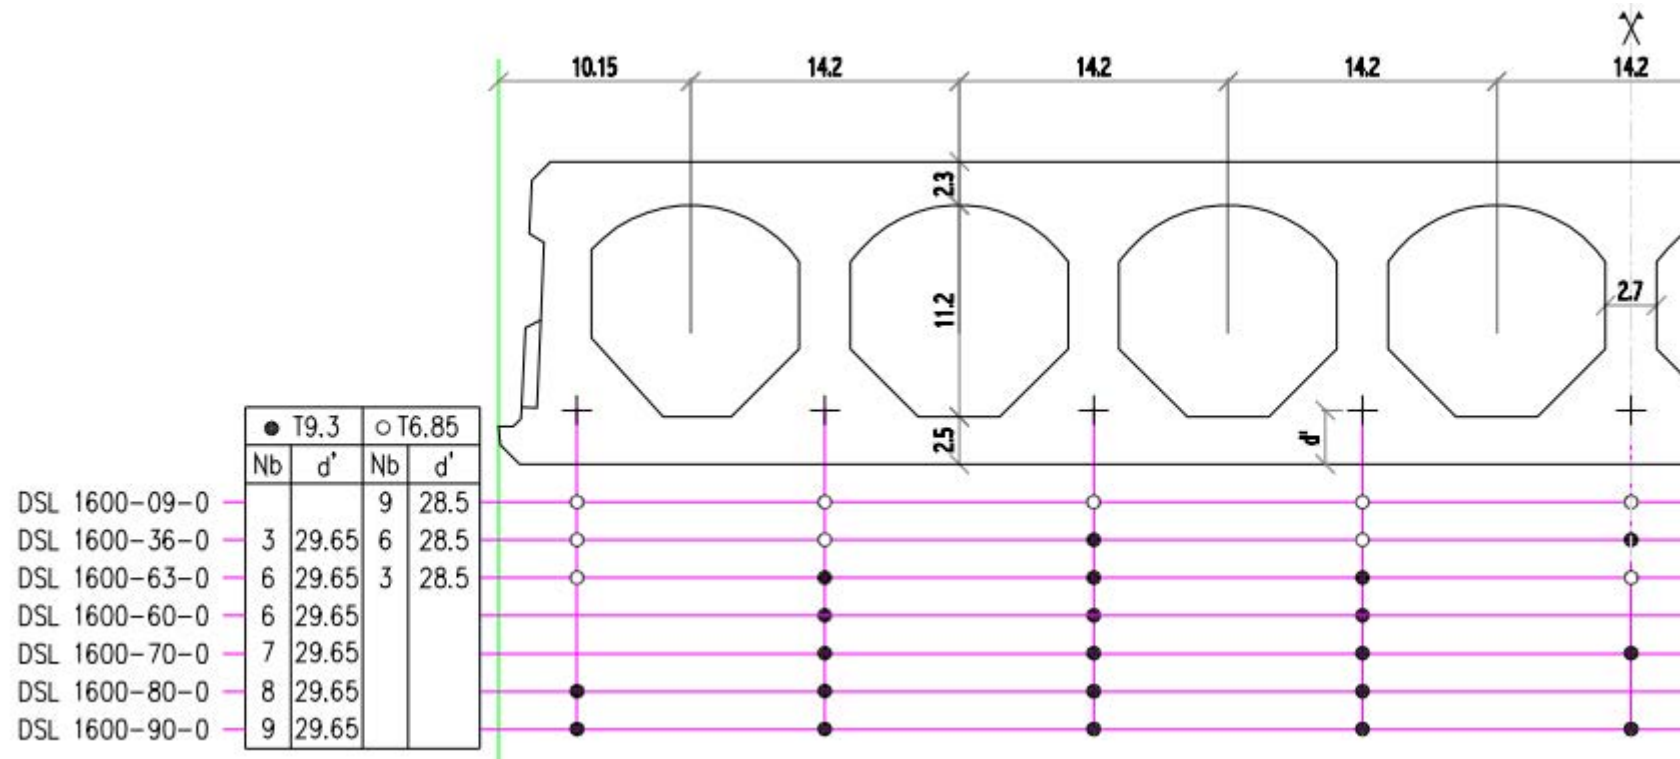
Dalle DSL 1600 - Position des armatures de précontrainte
